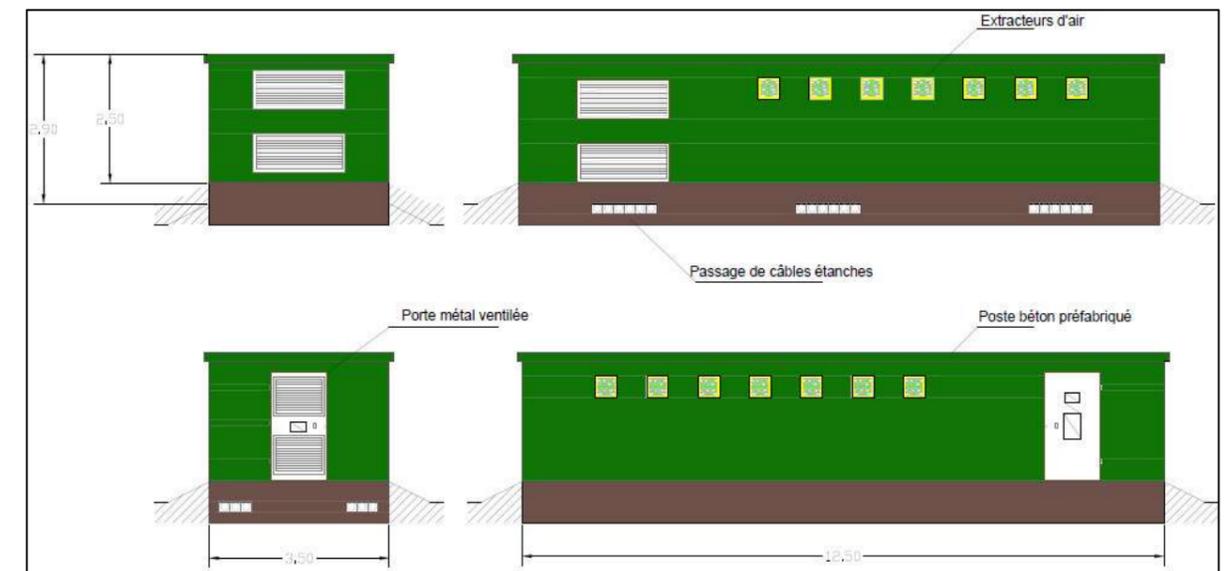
Plan de façade des postes de transformateur/ onduleur
